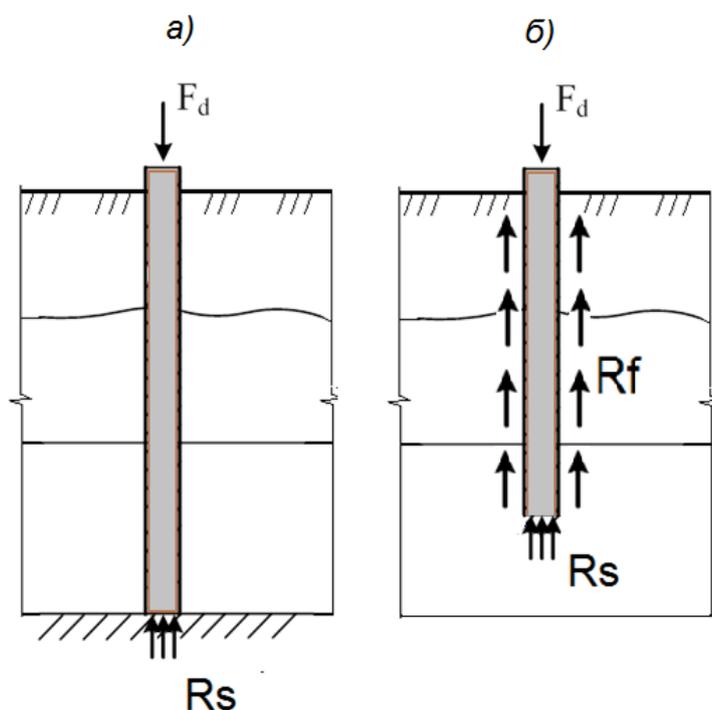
Виды свай по характеру передачи нагрузки на основание: а) – свая-стойка; б) – свая заземленная в грунте (свая трения)
